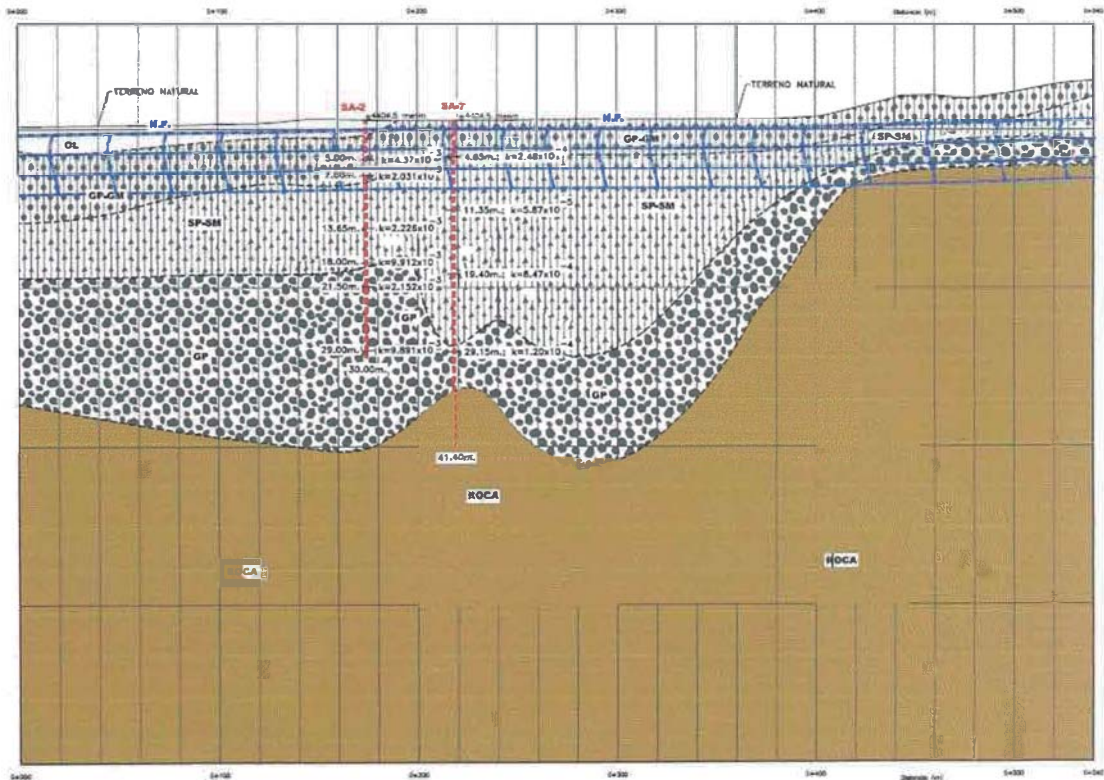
Perfil Estratigráfico del Sector de Emplazamiento de la Presa
